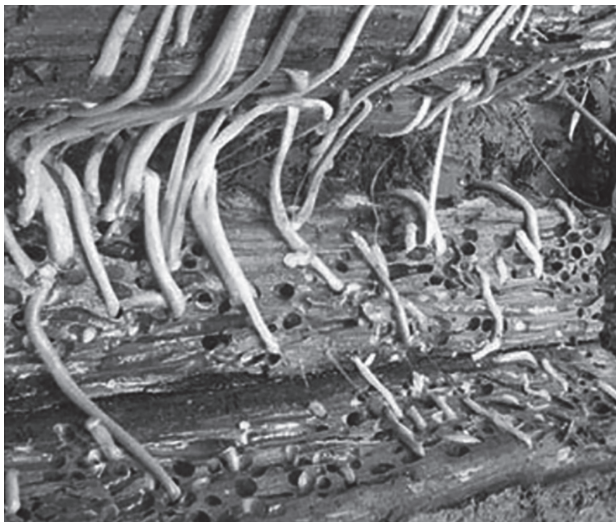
Pilote infestado por Teredo. Fotografía cortesía de Exponav (Fundación Raúl Vila).
